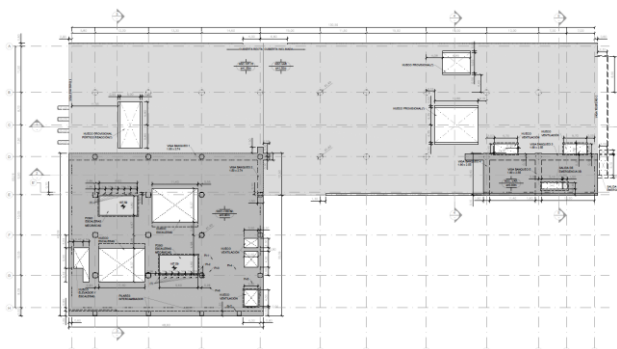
Planta losa cubierta (nivel calle) del proyecto original.
